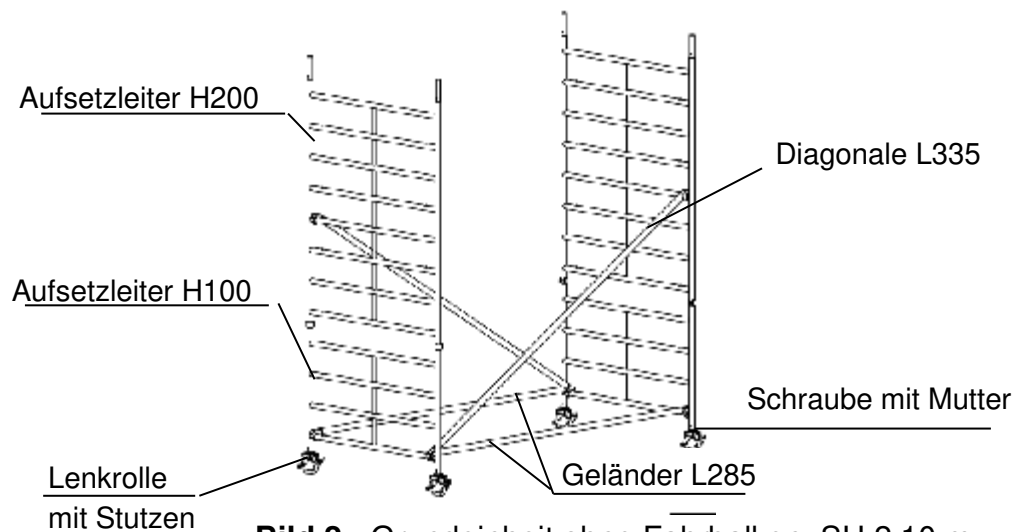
Grundeinheit ohne Fahrbalken, SH 2.10 m
